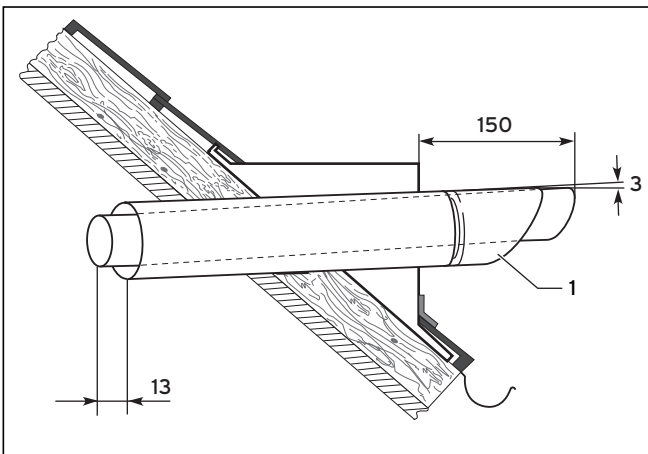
Einbau der waagerechten Dachdurchführung
